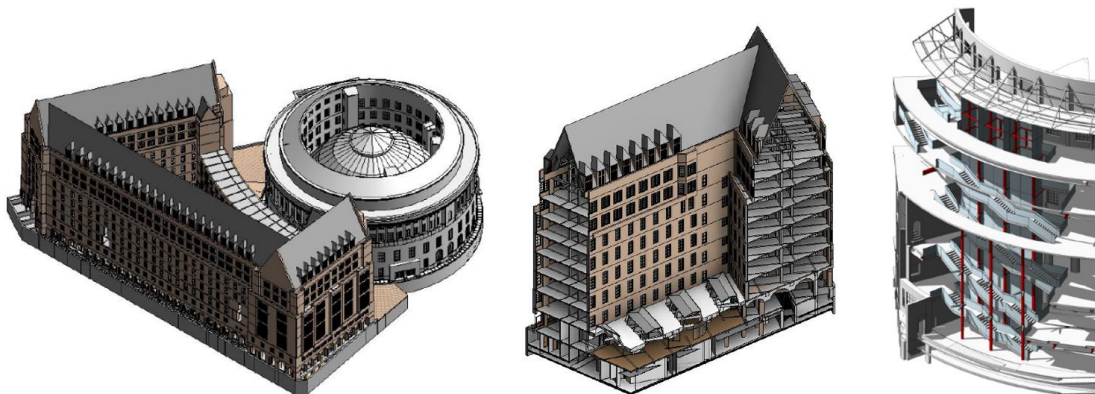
Complexo Town Hall e biblioteca central em 3D (Adaptado de Welch 2014)
